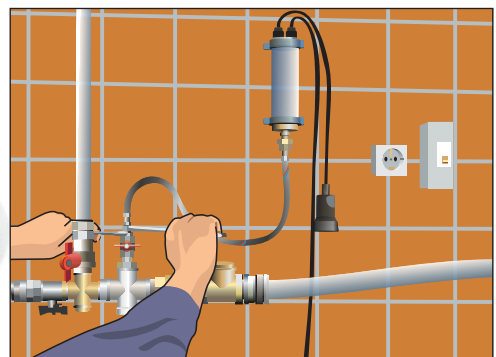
Подсоединяем второй конец шланга к крану водоснабжения
